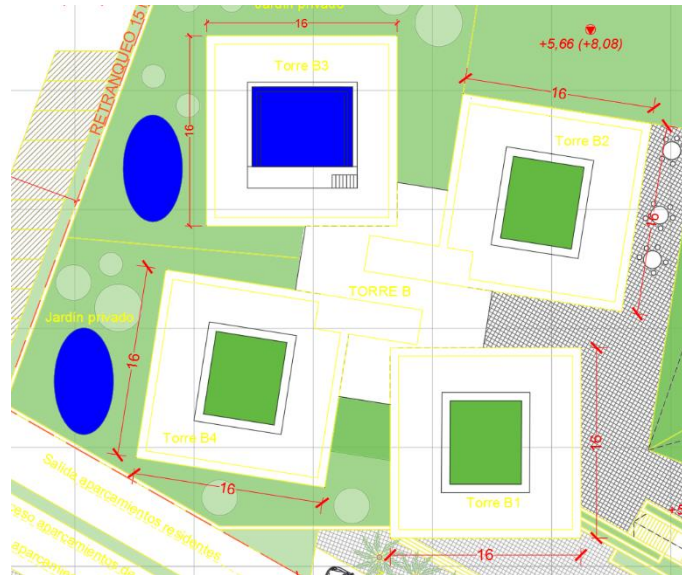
Vista en planta de la distribución de cada una de las torres en conjunto.
